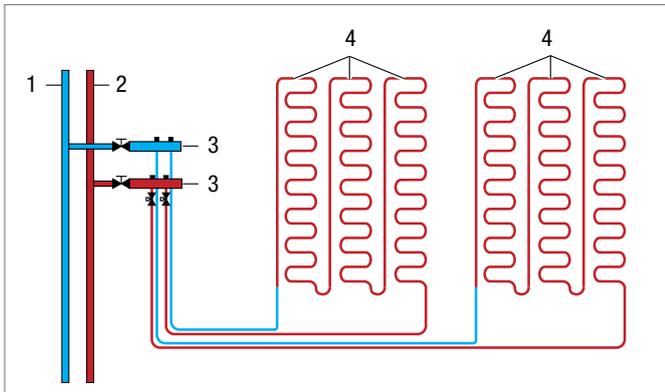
Rappresentazione schematica del collegamento in serie di più sezioni di riscaldamento a parete
